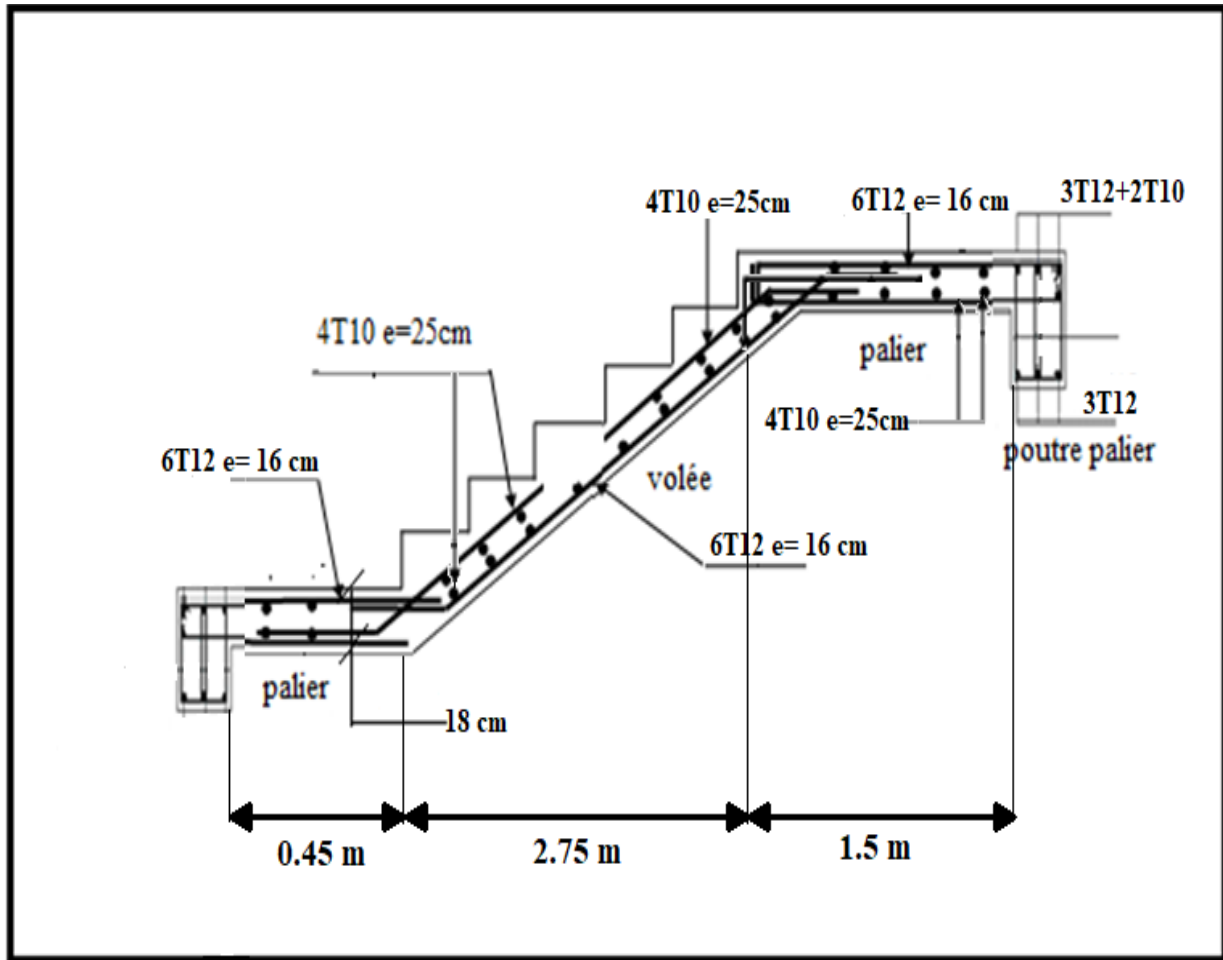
Schéma de ferrailage des escaliers et poutre palier.
